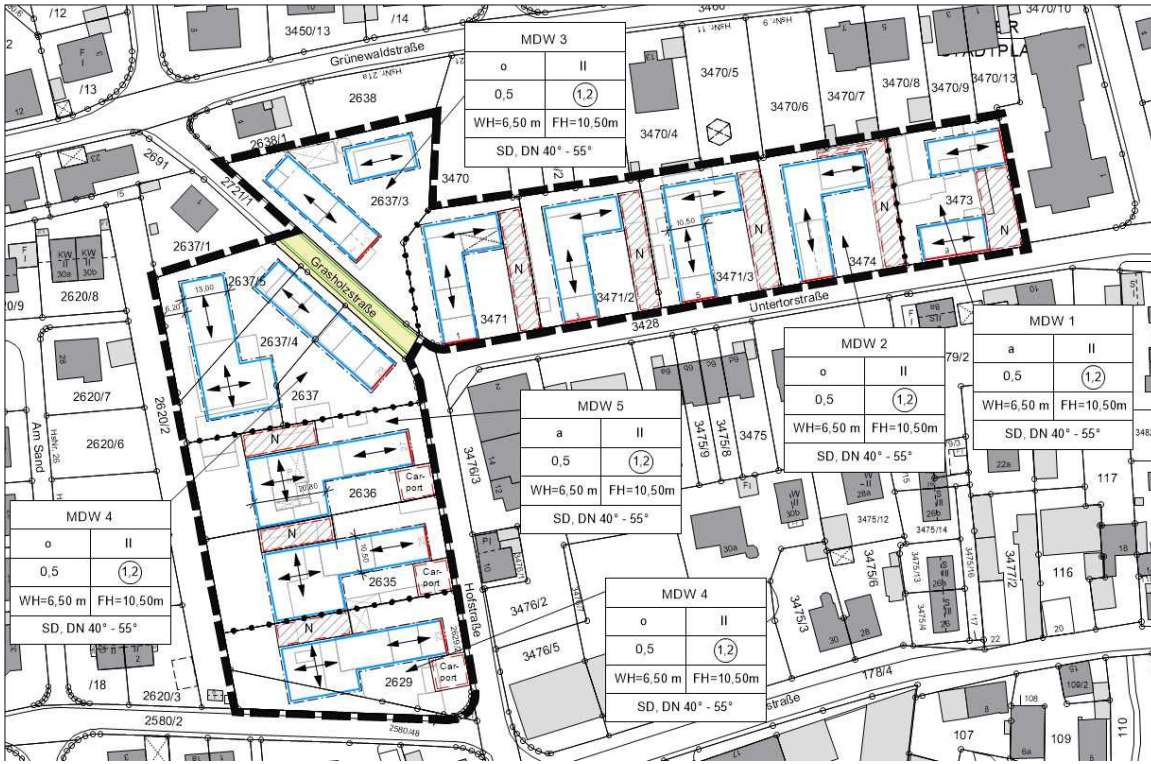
Planzeichnung der 1. Bebauungsplanänderung „Bauernsiedlung“
